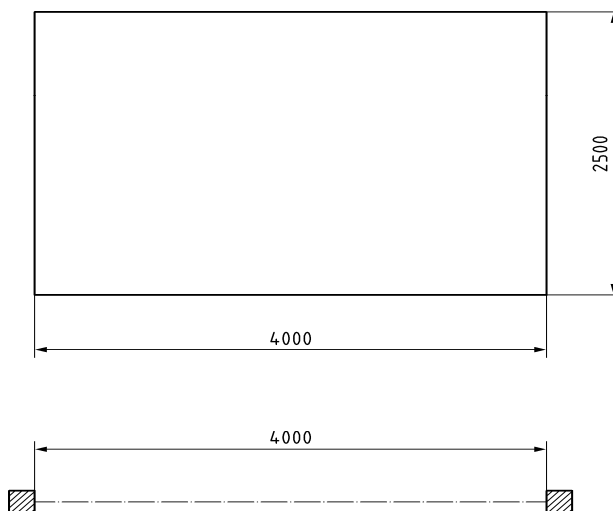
DIMENSION DU DISPOSITIF D’ESSAI
